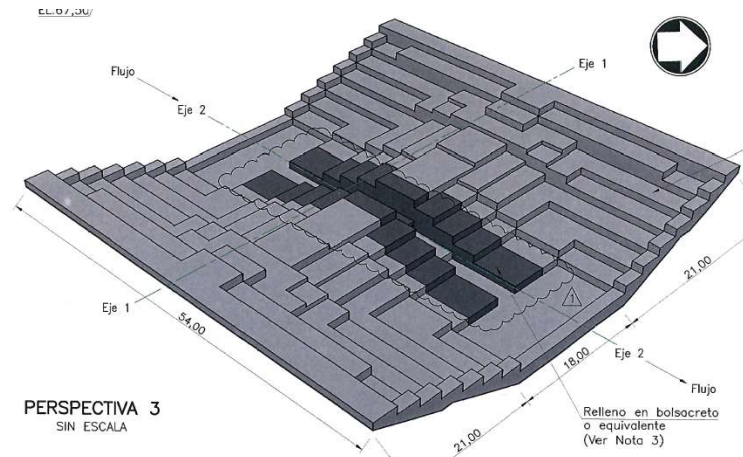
Diseño y construcción de la Estructura Caño San Silvestre.
